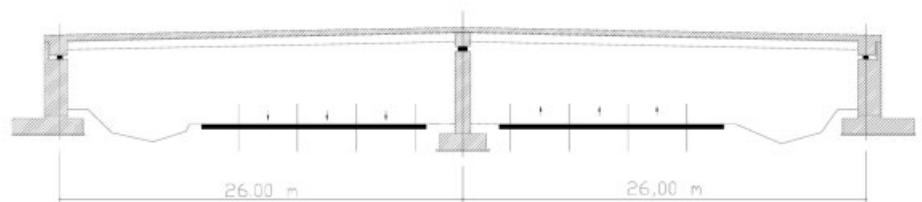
Ü-Bauwerk: Spannbetonbrücke als Zweifeld-Träger
